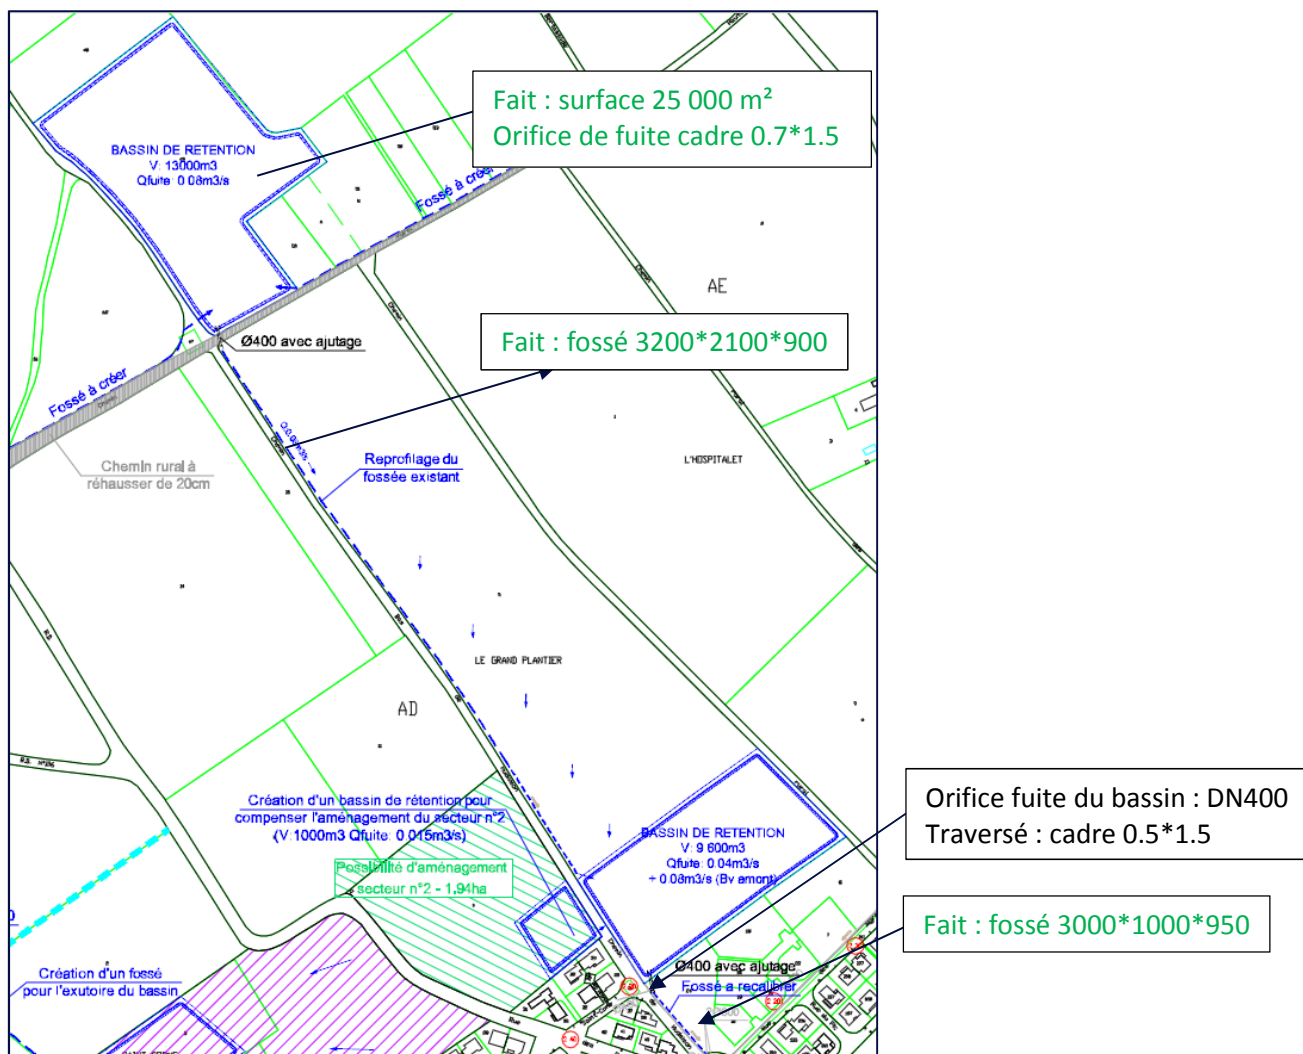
Aménagements prévus sur le secteur amont plan d'Ormeau (source : Etude hydraulique plan d'Ormeau - 2006 - BCEOM)
